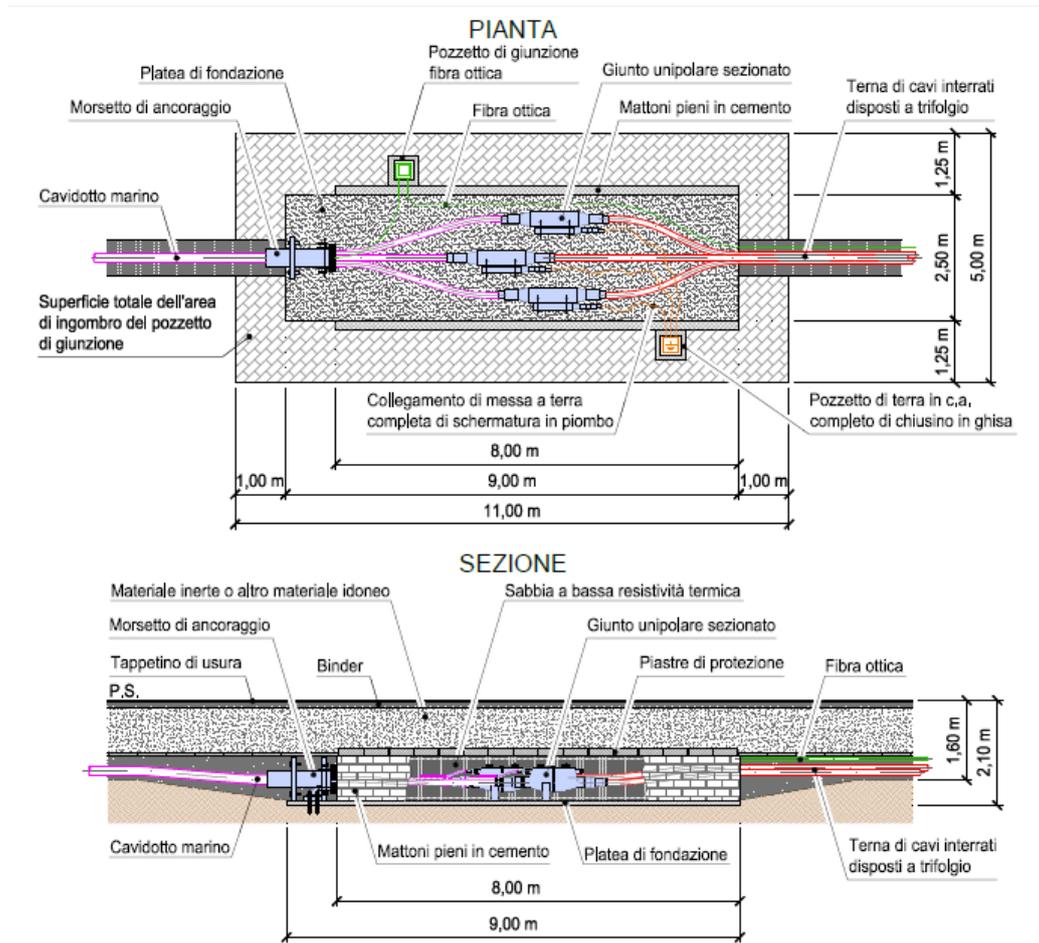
Pianta e sezione tipiche del pozzetto di giunzione (Elaborazione iLStudio)
